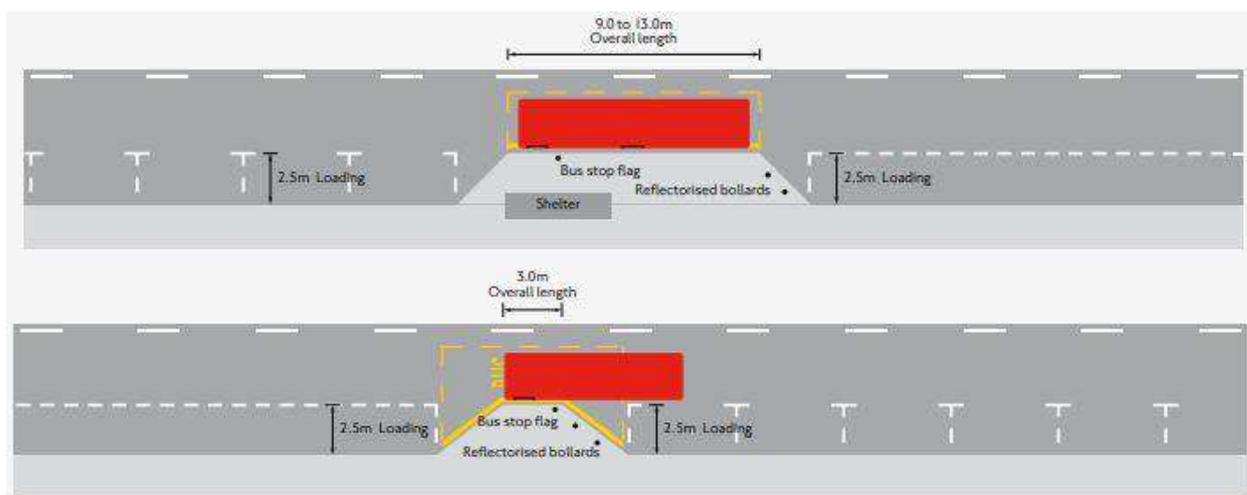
Остановочный пункт типа с малоразмерным выступающим бордюром
